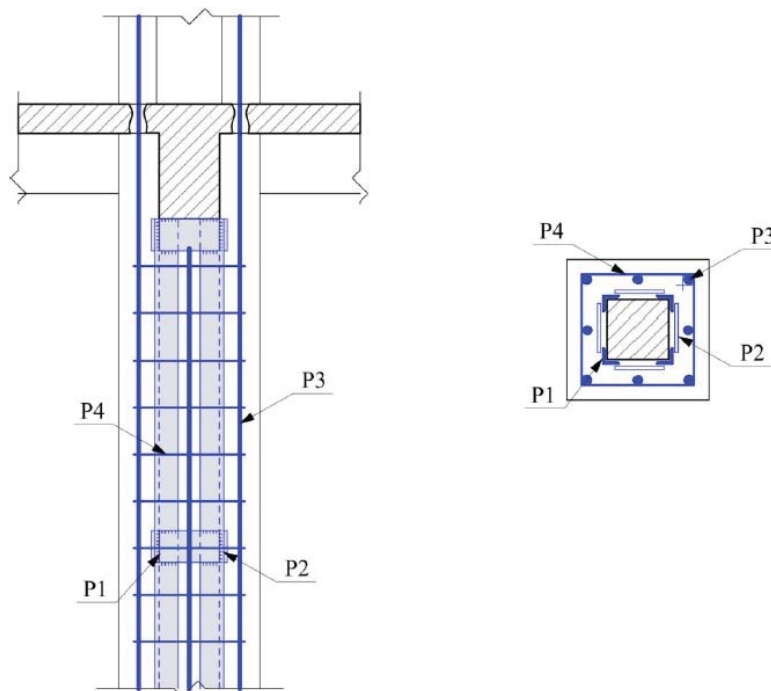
Refacerea capacității portante la stâlpi de beton armat prin suplinirea parțială a betonului și armăturilor cu profile rigide din oțel rigidizate prin platbenzi sudate și protecția cu carcasă din oțel beton înglobată în beton nou turnat
